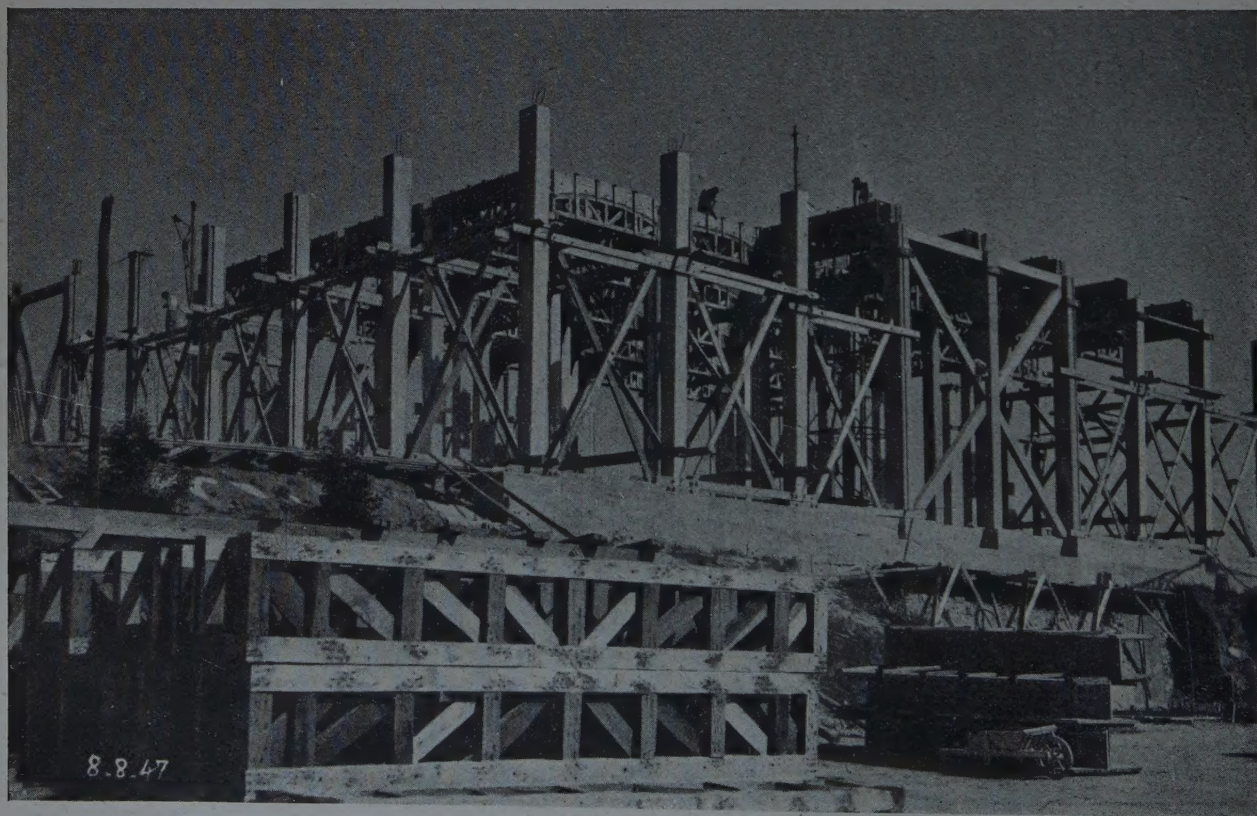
Mise en place des coffrages des nervures du fond.
